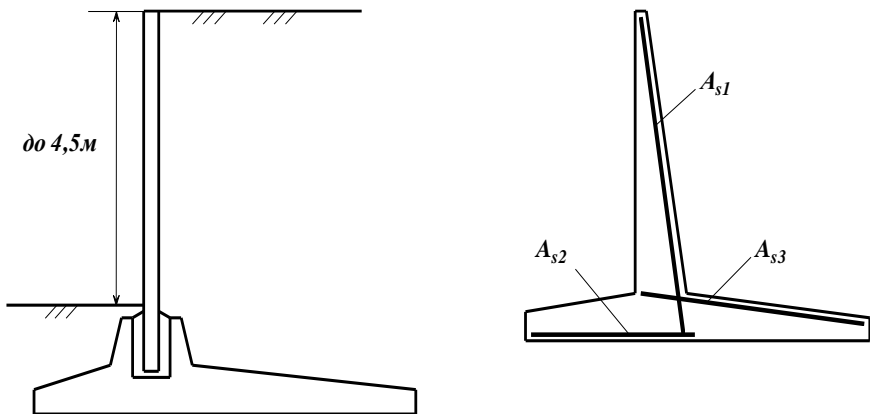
Конструкція та армування кутової підпірної стінки
